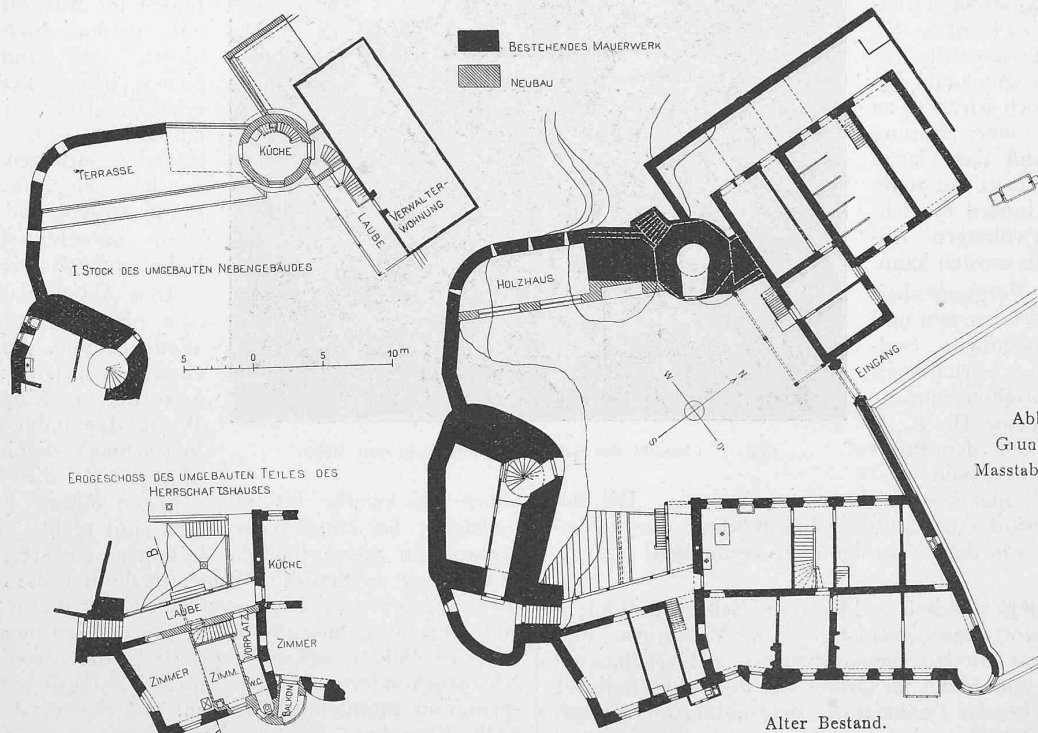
Grundrisse. Masstab 1 : 500.
